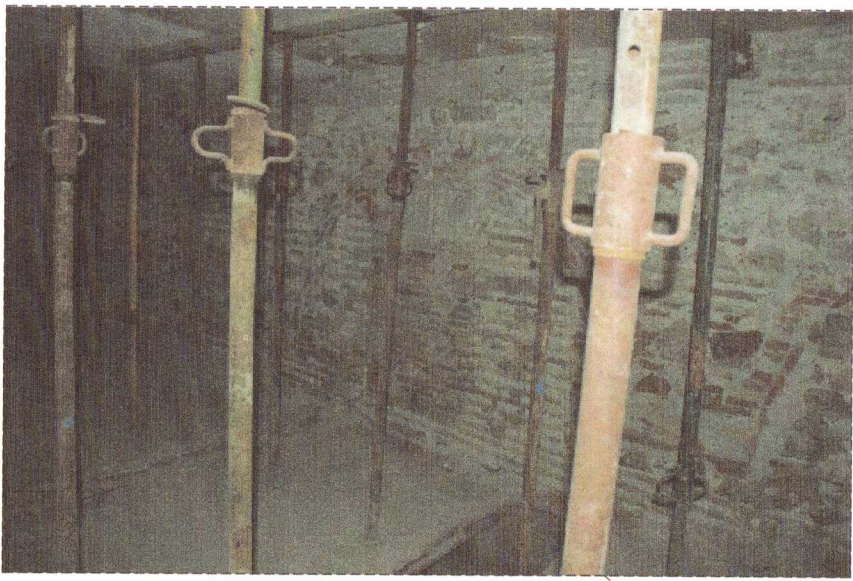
PARTE INTERIOR DE FACHADA A PATIO CON RESTOS DE ARCOS CONSERVADOS (NIVEL PLANTA BAJA)
